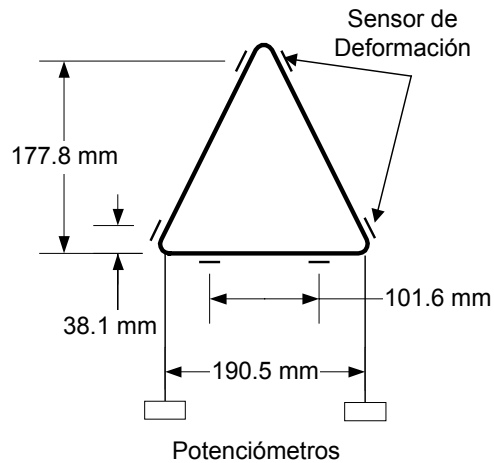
Localización de los sensores de deformación en vigas triangulares.
